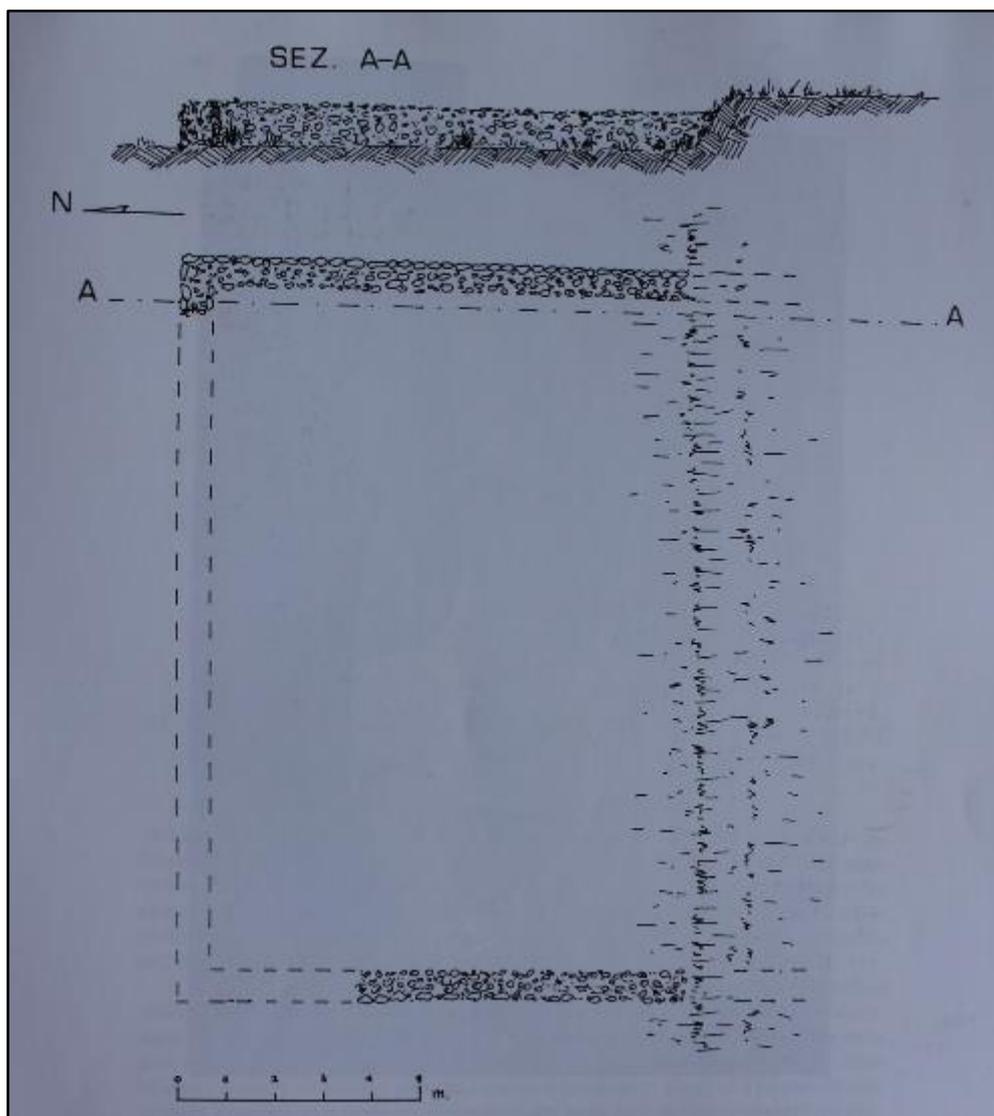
Pietramelara, S. Nicola: pianta e prospetto delle murature in opera cementizia (da: CAIAZZA 1995).
